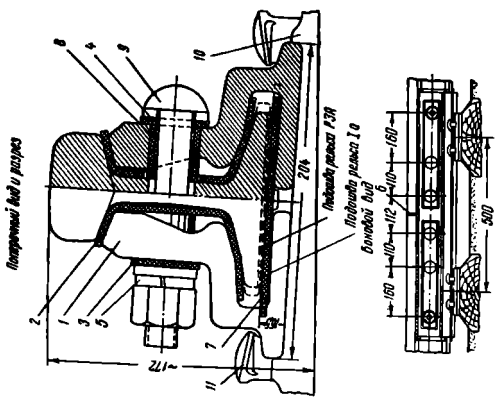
Детали стыка для рельсов Р43, Р38 и I-a
